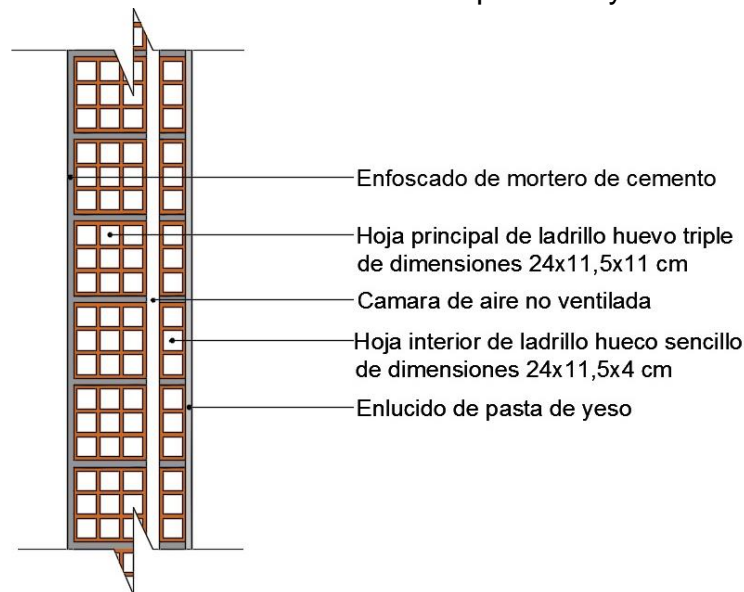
Sección constructiva del cerramiento de la fachada principal del edificio
